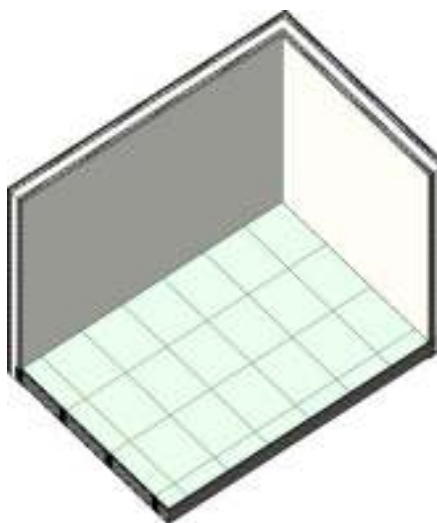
Esquema de montagem do revestimento de pavimento.
